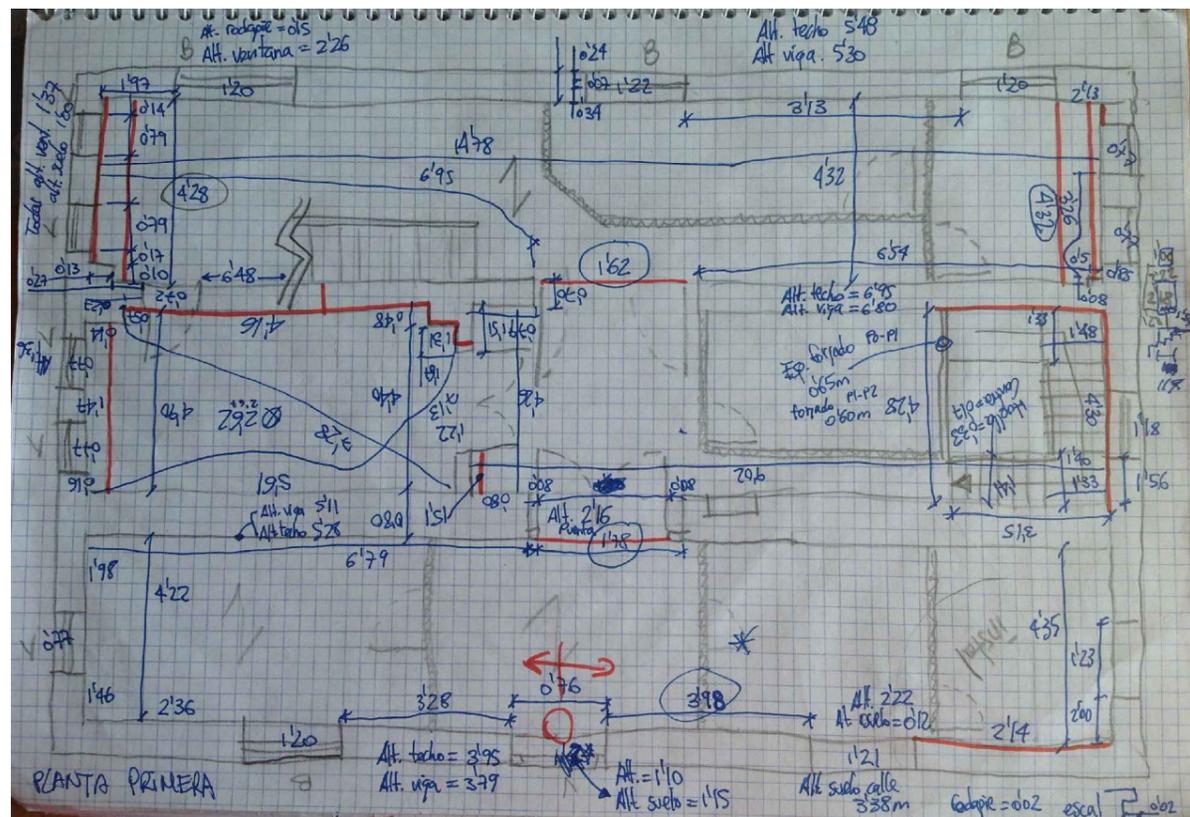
Planta primera. 2014. Fuente: elaboración propia.
